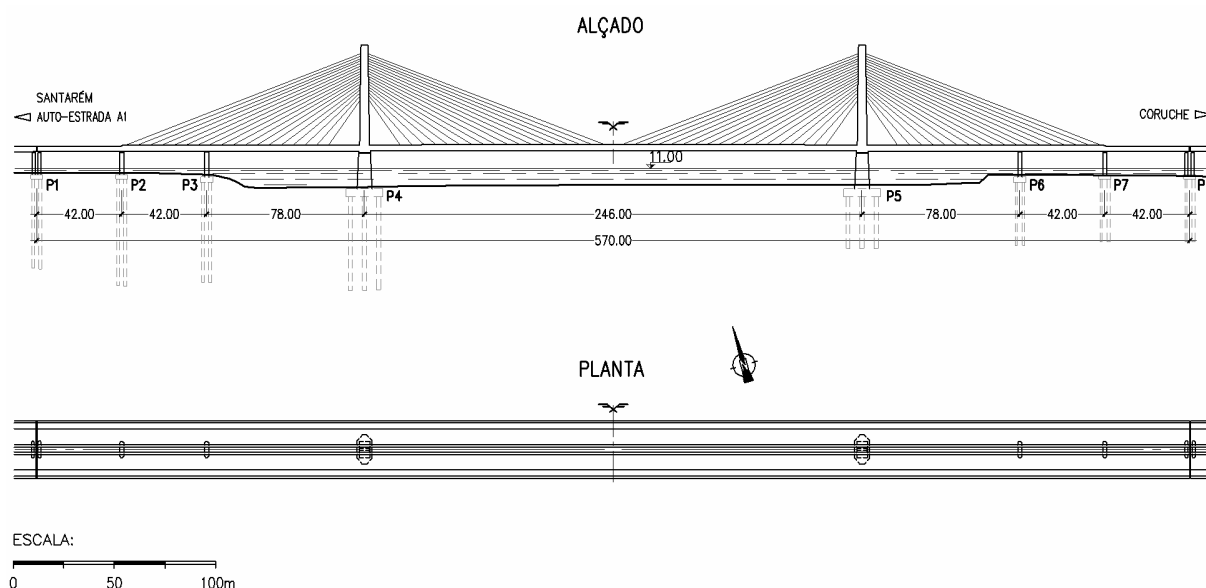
Alçado e planta da Ponte Salgueiro Maia
